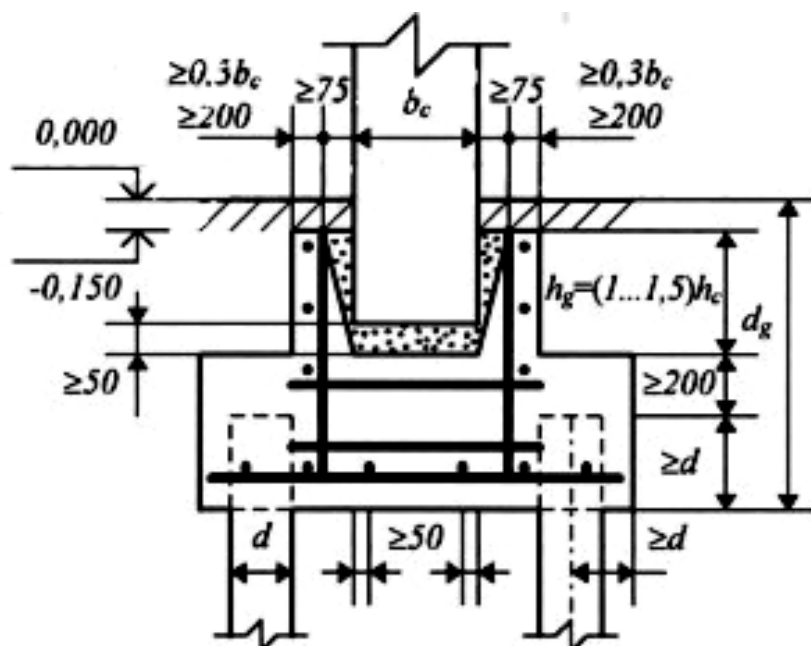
Пальовий фундамент під збірну залізобетонну колону
